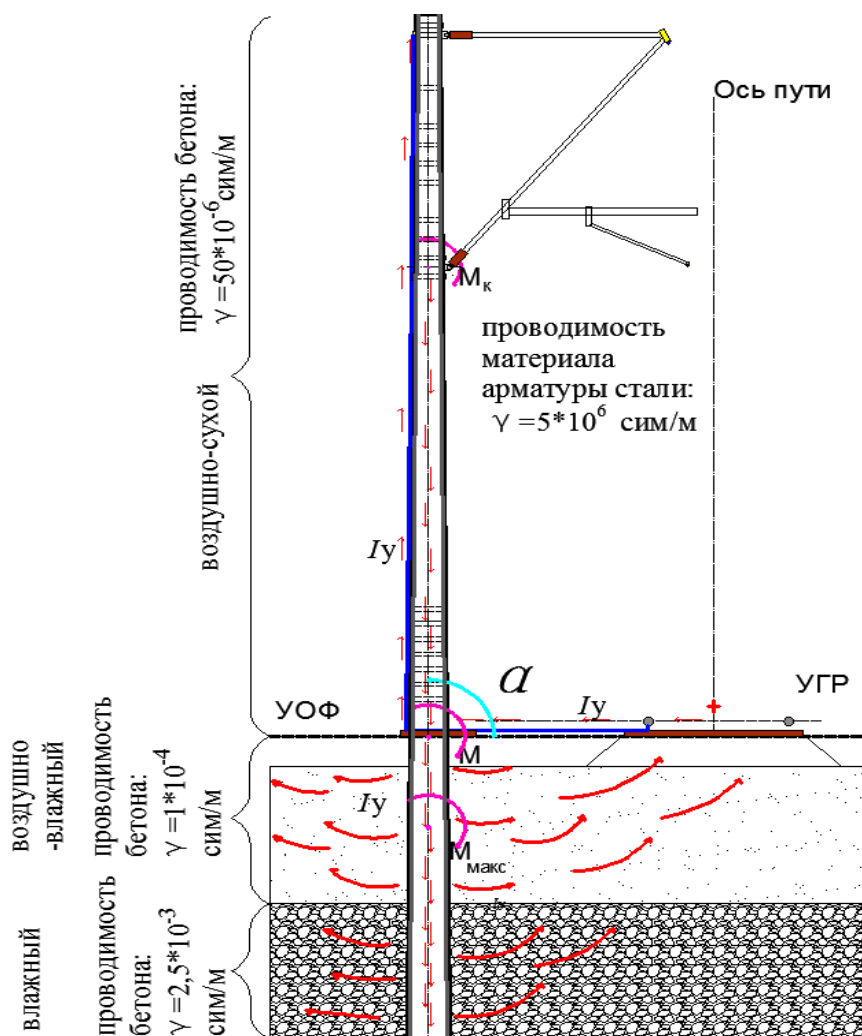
Схема протекания токов утечки в железобетонной опоре контактной сети
